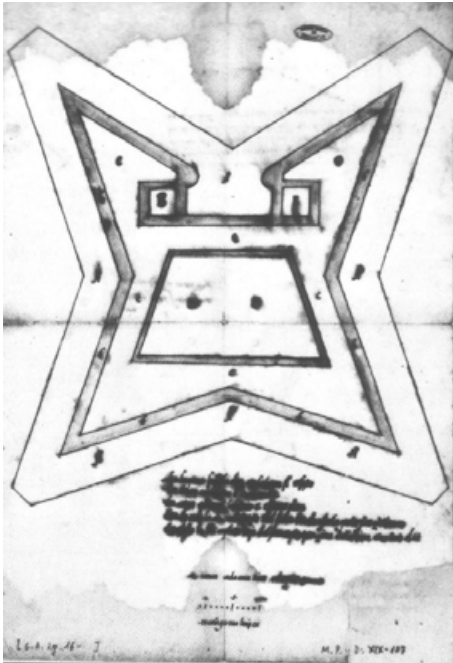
Pianta del forte Sant’Elmo a Malta (Francesco Laparelli).
